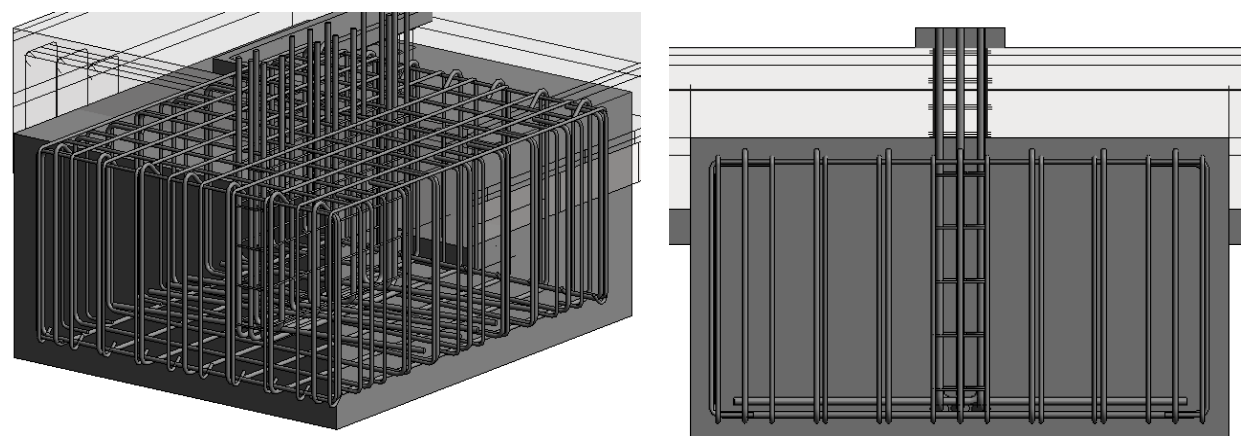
Modelos 3D de armaduras – Sapata S3 – 150 x 180 x 85 cm³
